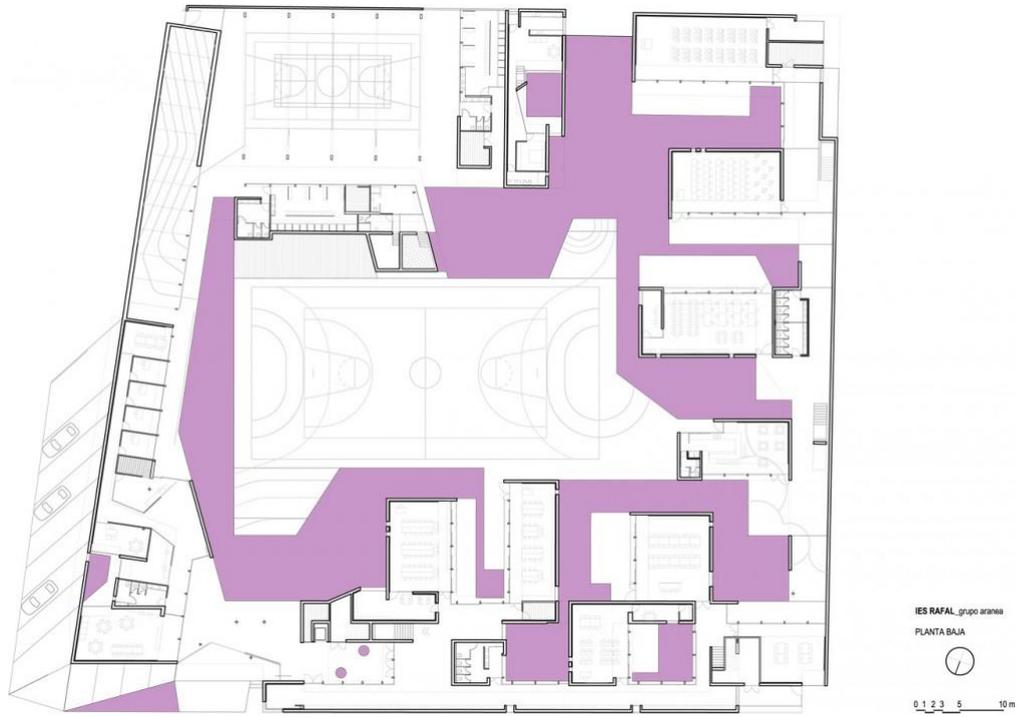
PLANTA PRIMEIRO PAVIMENTO
